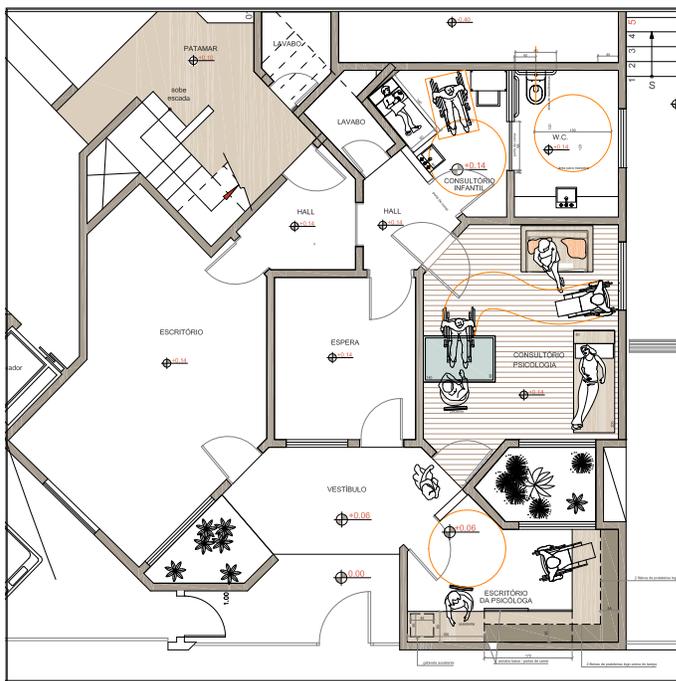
Planta do consultório como construído. FONTE: levantamento de campo
